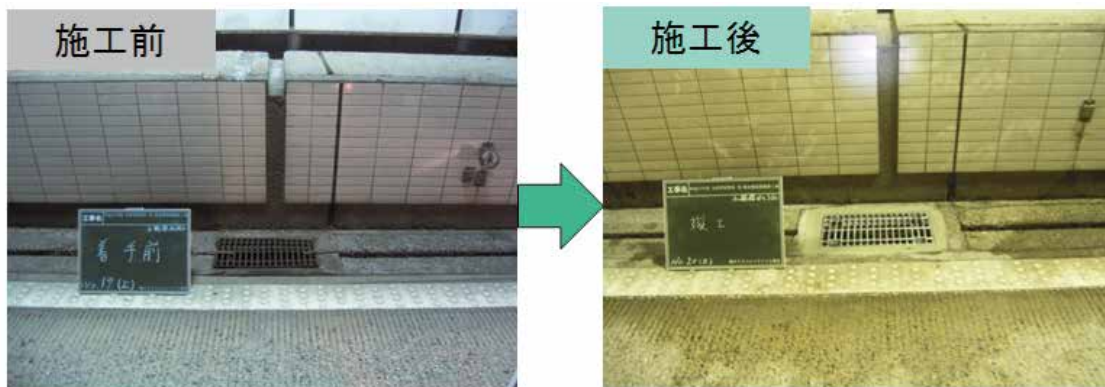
高速道路本線（トンネル内）集水柵上部改修 施工事例
